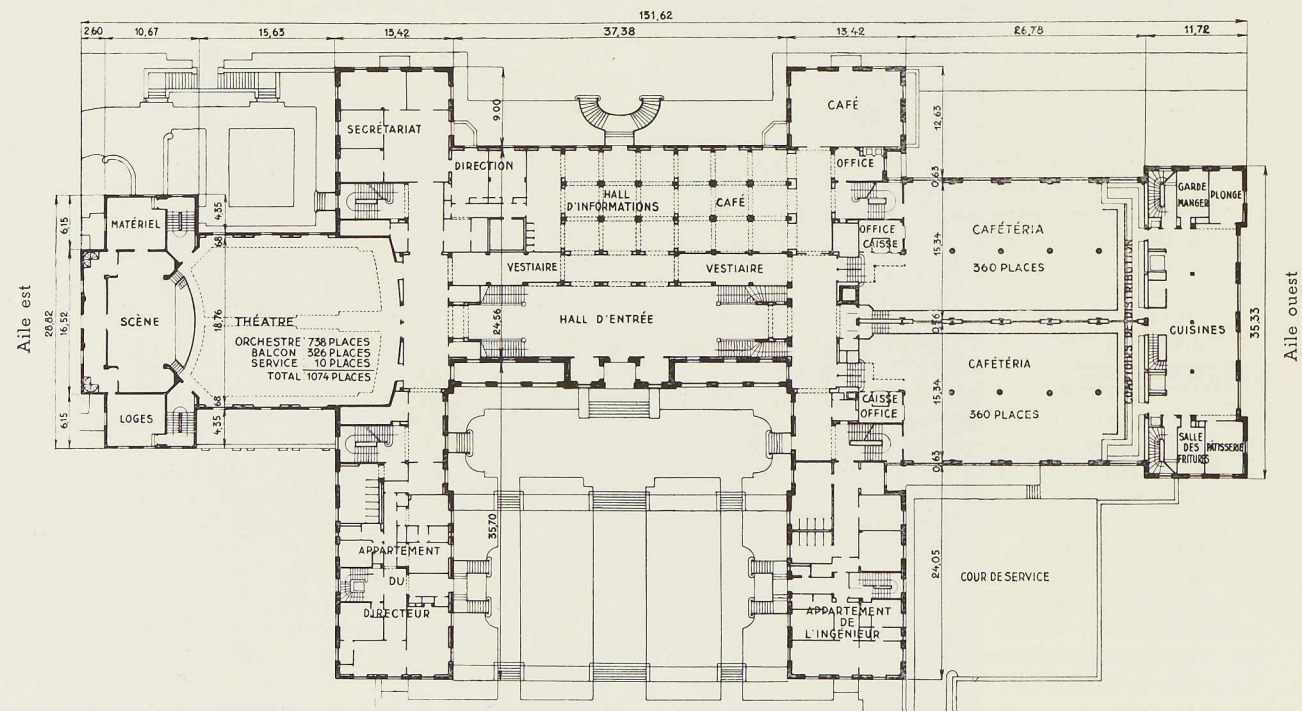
Plan du bel-étage à même échelle que le plan de l'ossature métallique.
